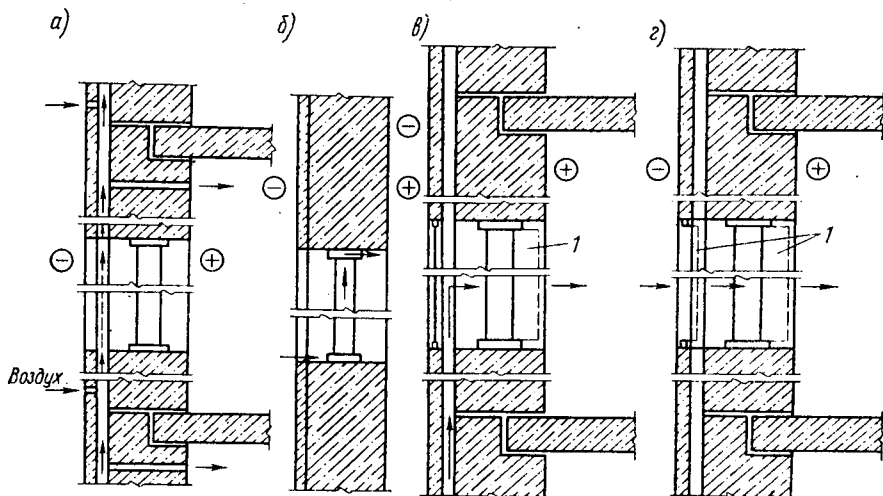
Принципиальная схема проветривания помещений при вентилируемых и неветилируемых наружных ограждениях с утепленными экранами:
